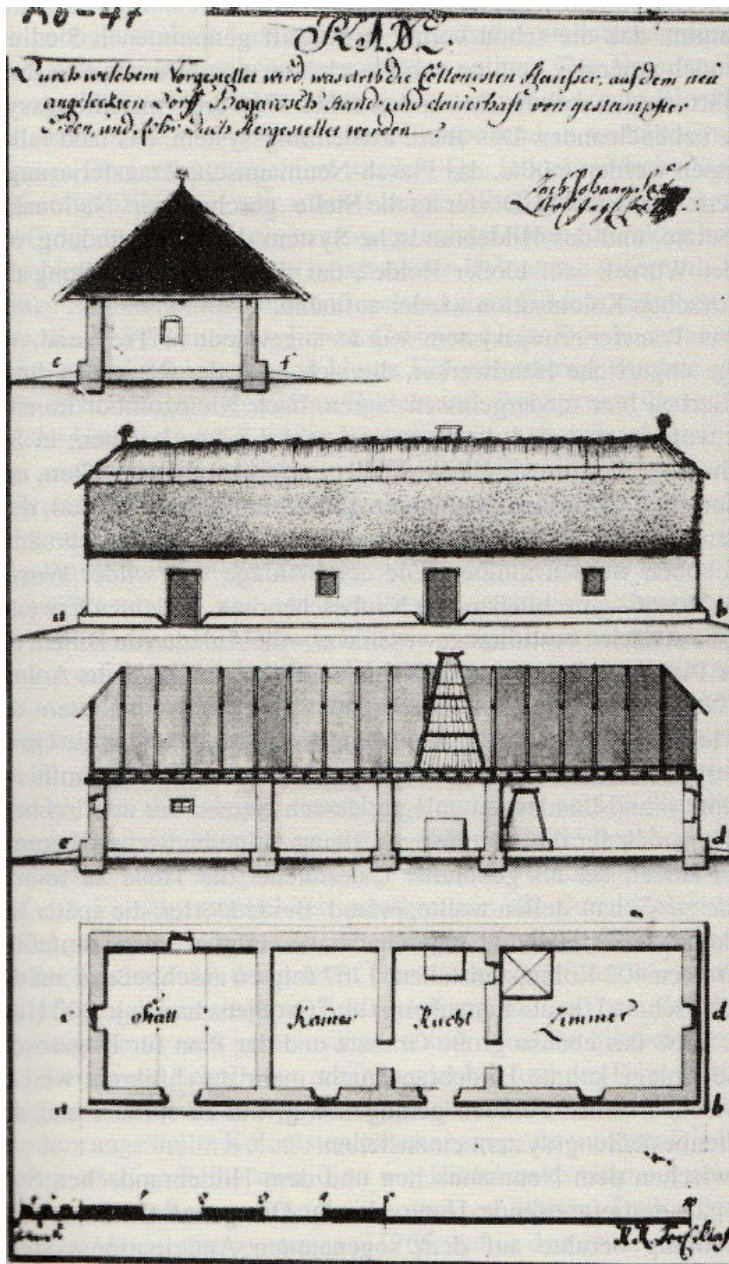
Plan eines typischen Kolonistenhauses 1769
